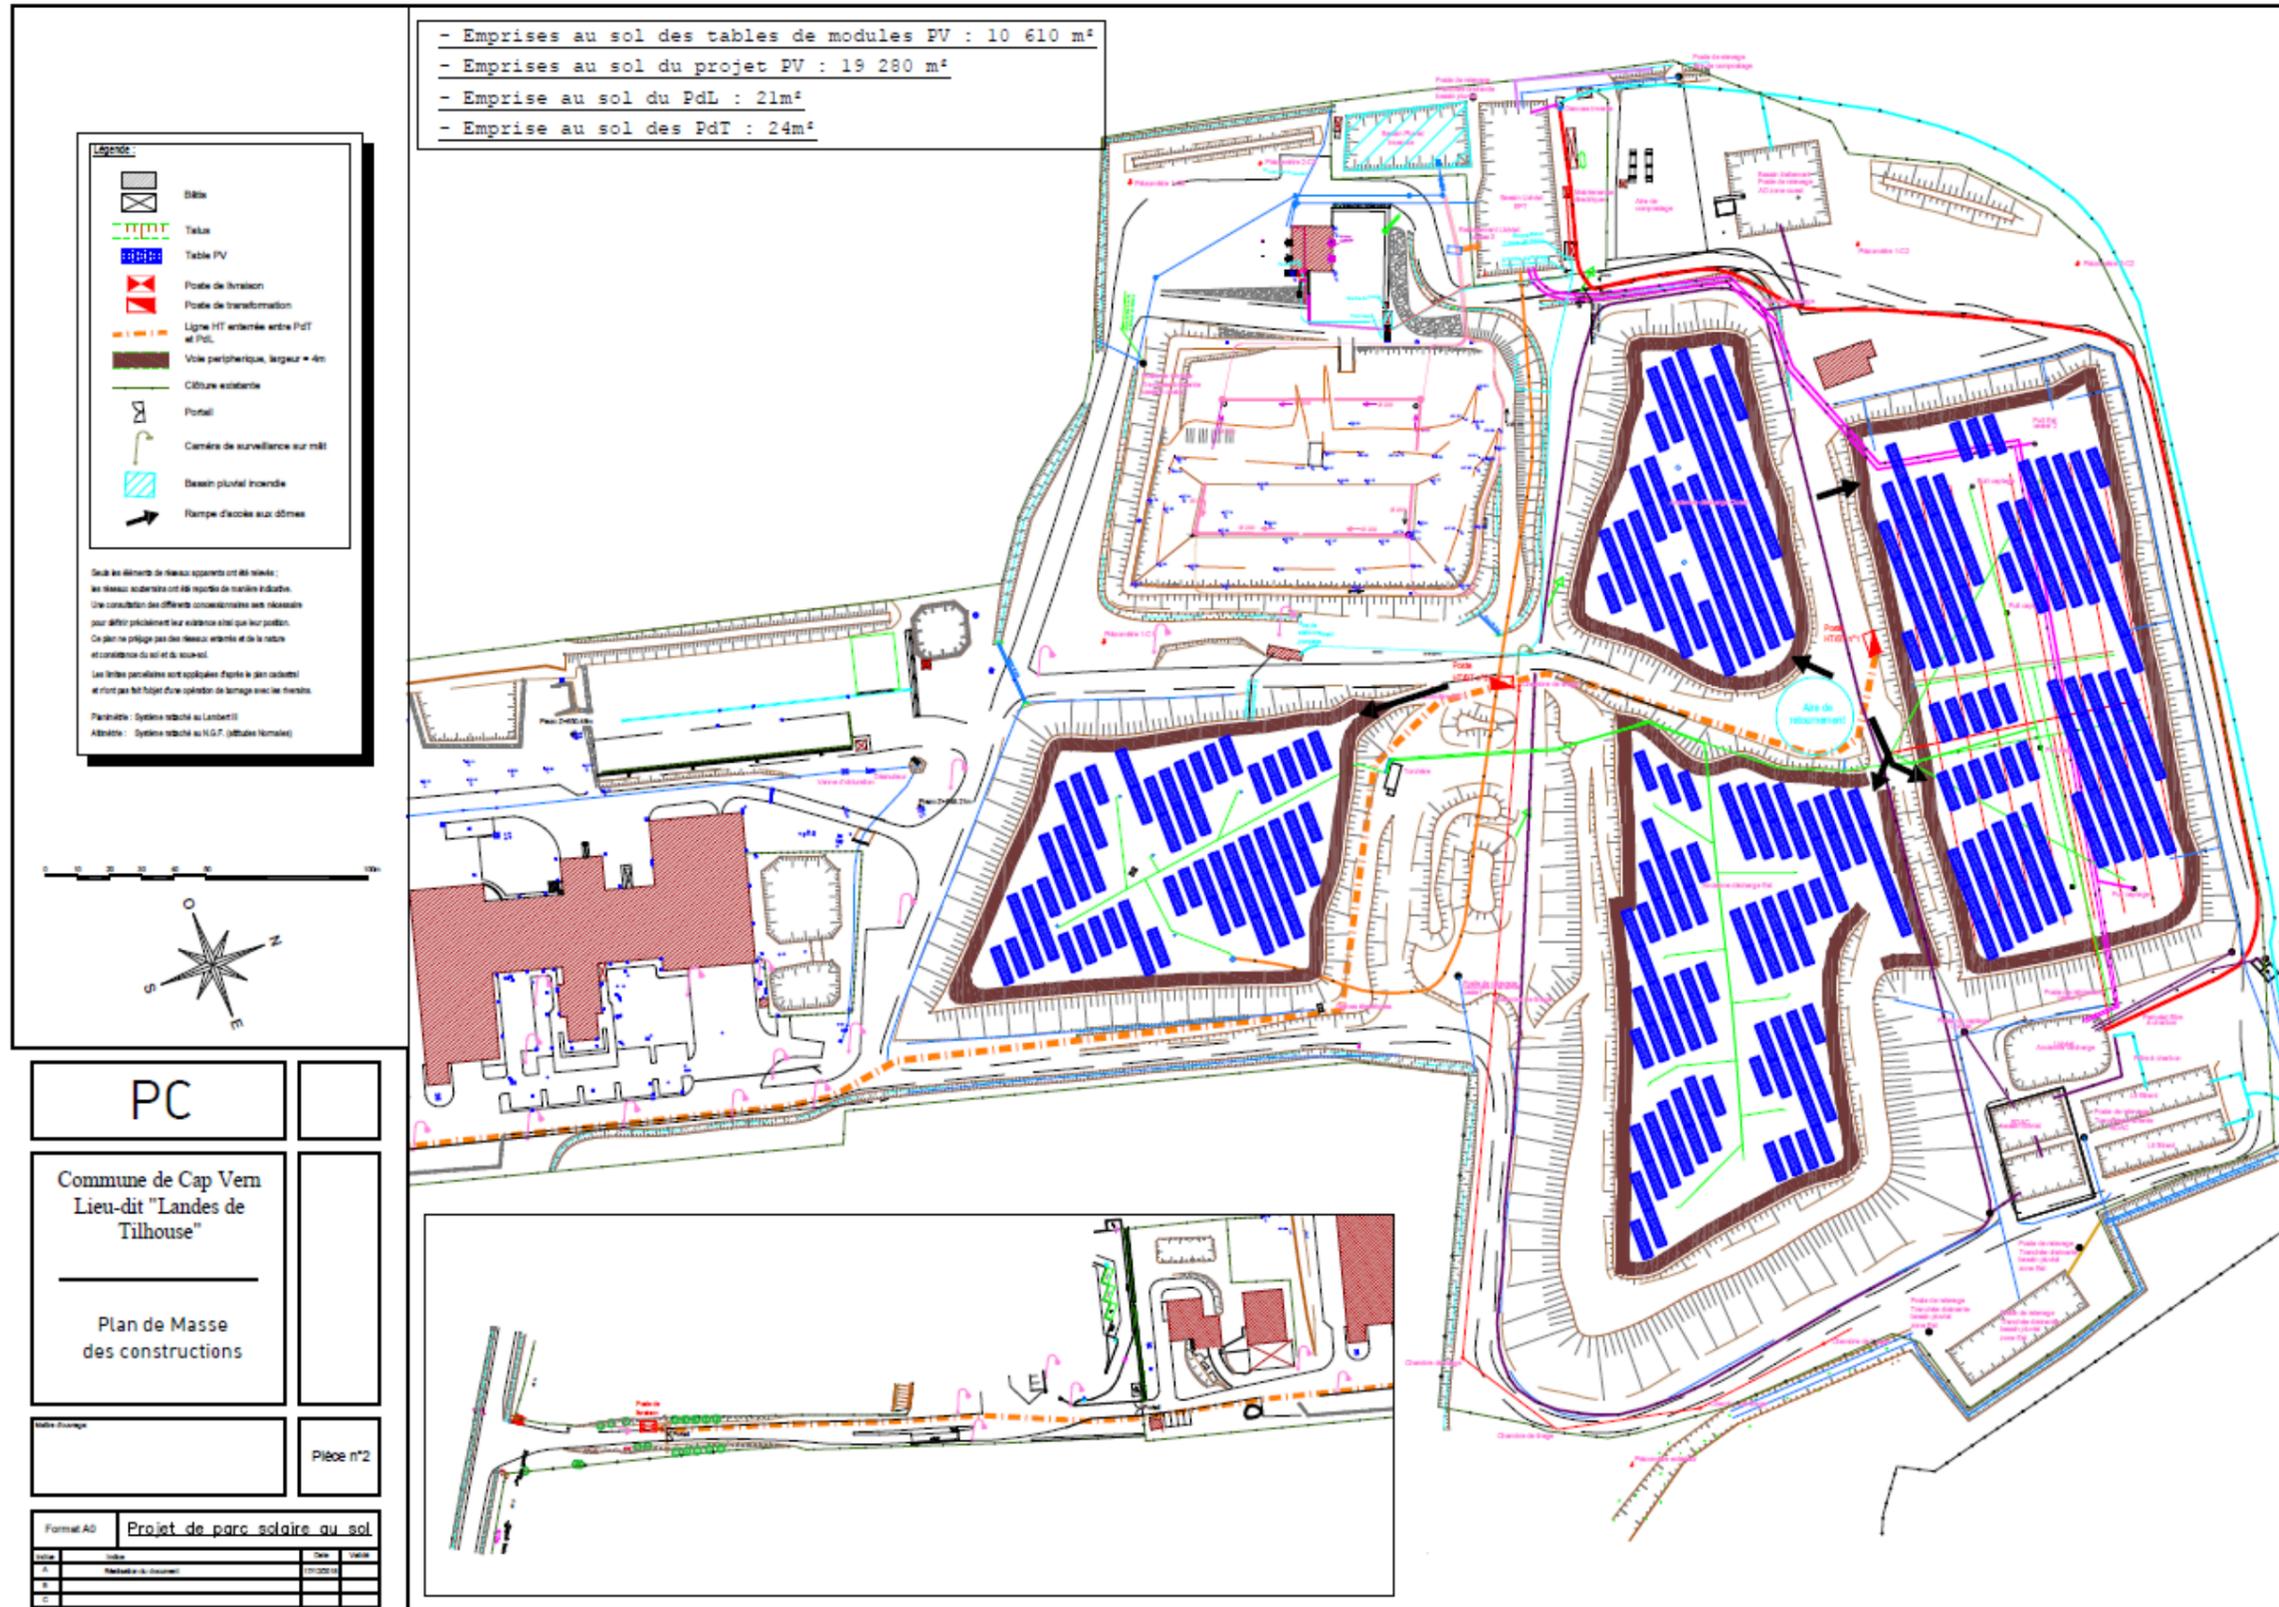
Plan masse de la centrale photovoltaïque de Capvern
